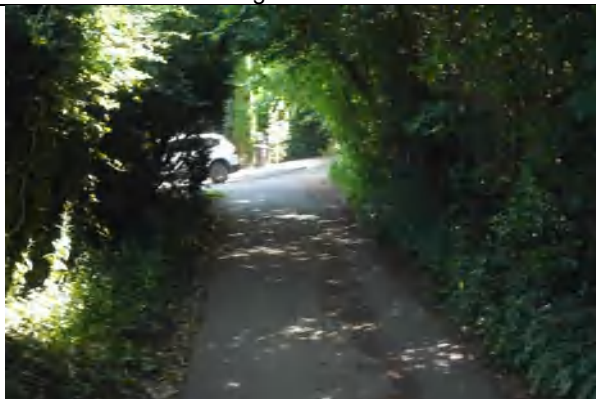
Zufahrt Gehrstr. bergauf in Richtung Süden
